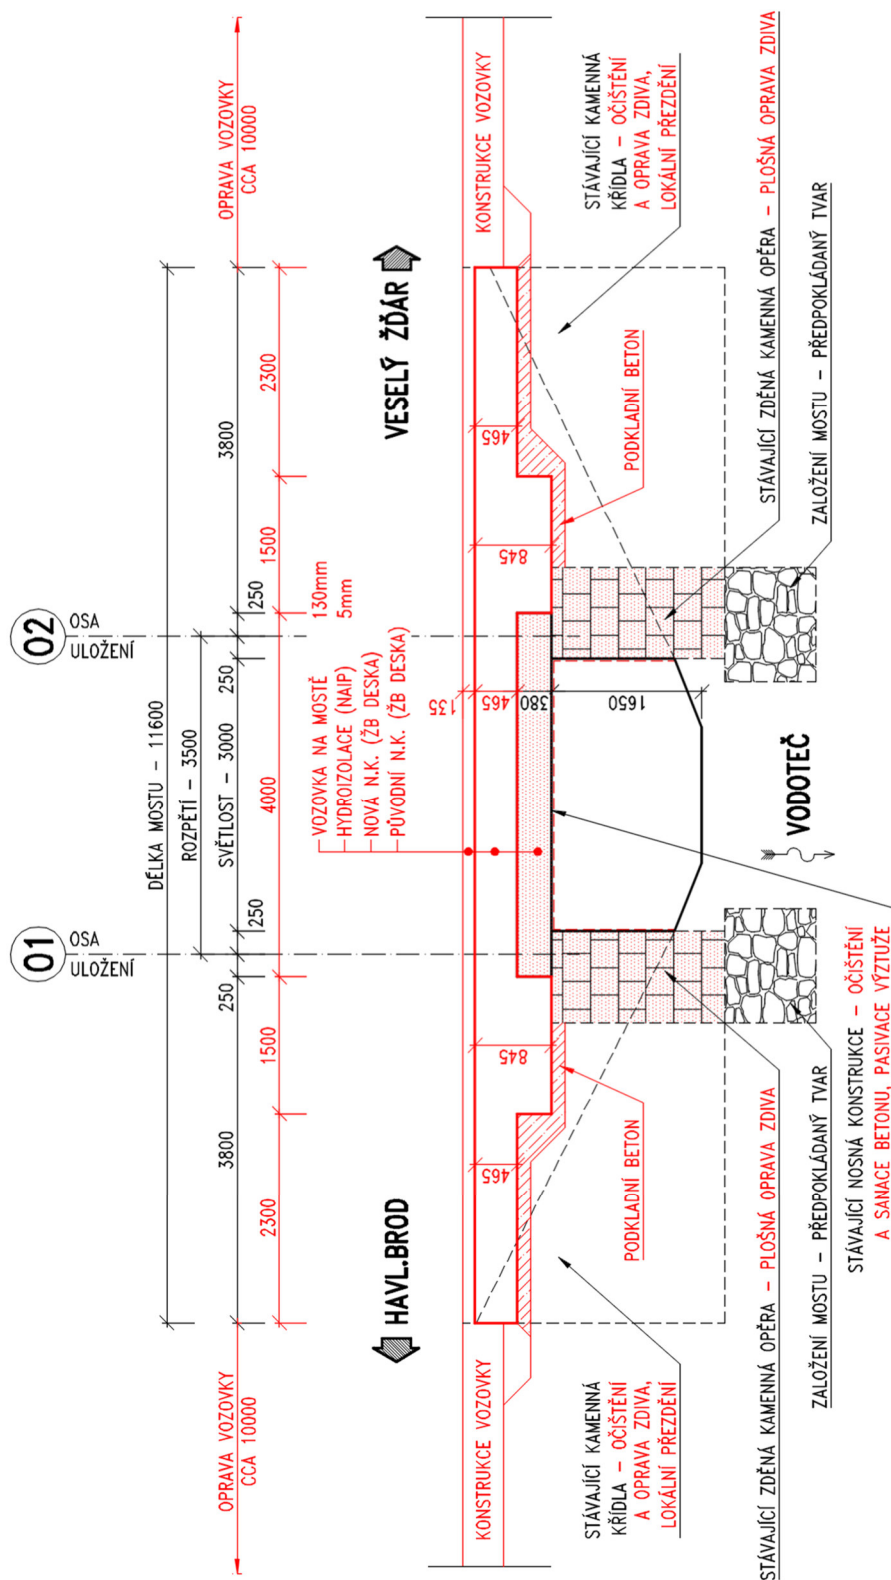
Schéma opravy Varianta A – Příčný řez
